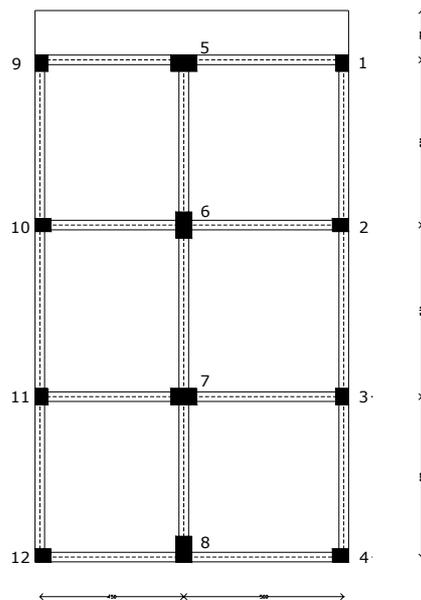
Schema della carpenteria e del telaio da realizzare
